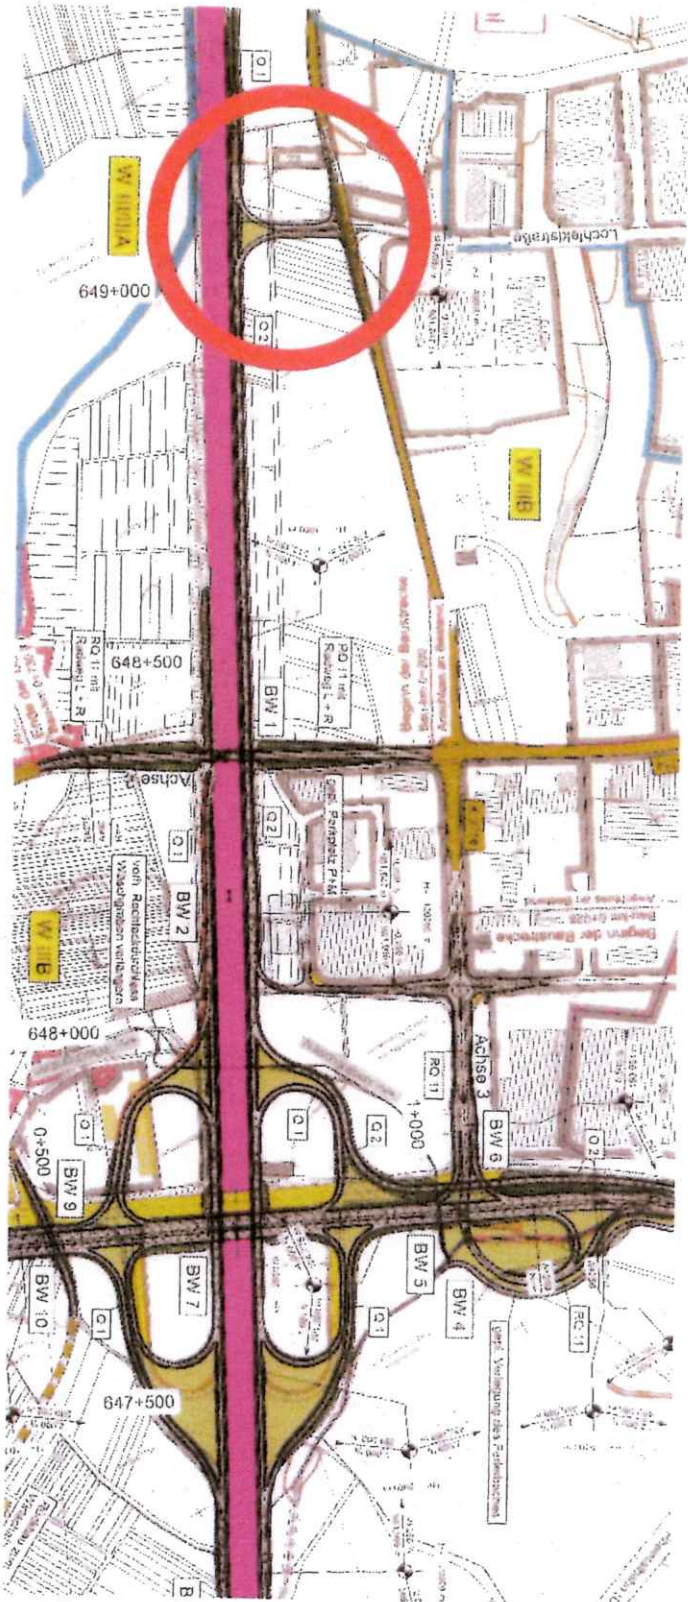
Ausschnitt Lageplan Parallelaufstellung ohne Schleppkurven (vgl. Anlage 1: Lageplan Parallelaufstellung ohne Schleppkurven)
